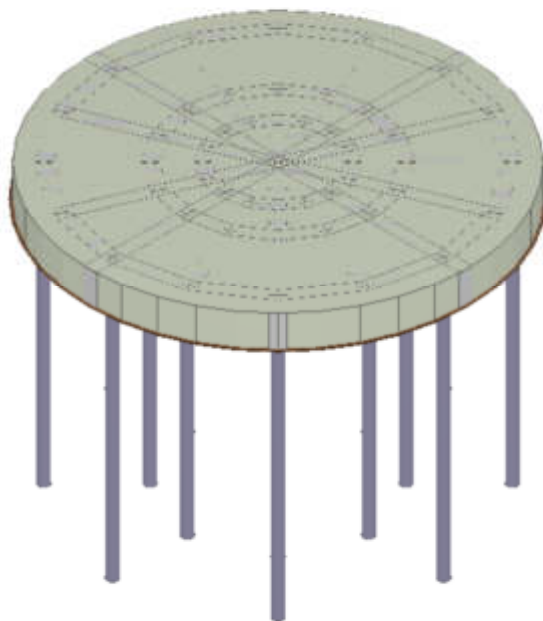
schema tridimensionale di fondazione – Plinto su pali
